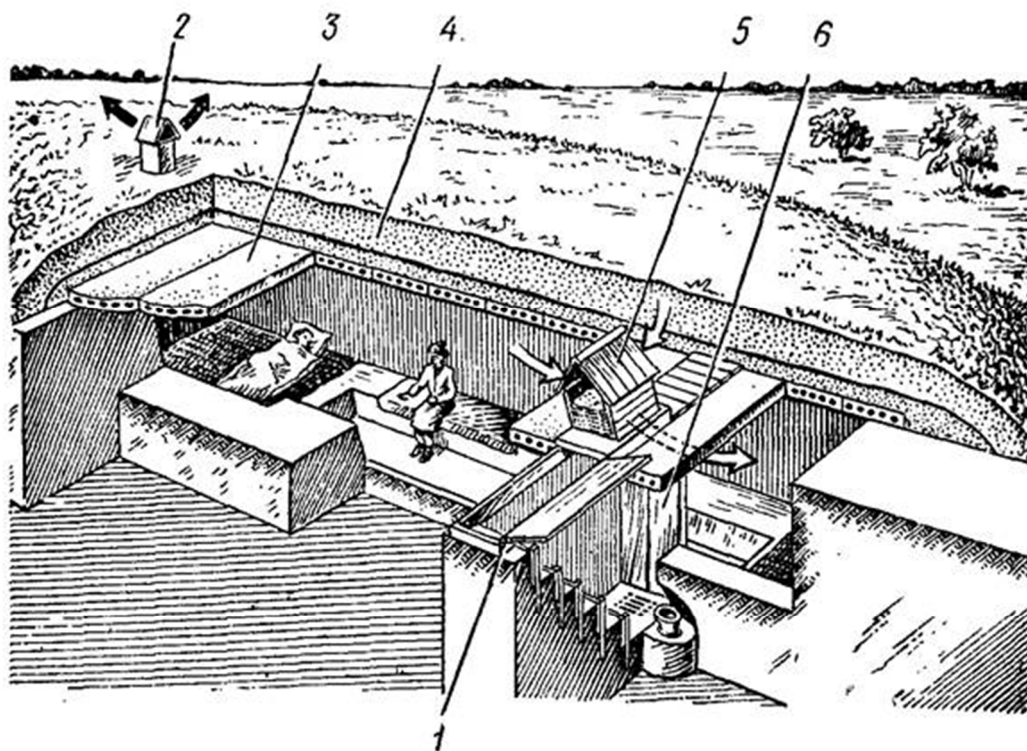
Противорадиационное укрытие с перекрытием из железобетонных плит: 1 – вход; 2 – вытяжная шахта; 3 – перекрытие; 4 – обсыпка грунтом; 5 – приточная шахта; 6 – занавес при входе.
